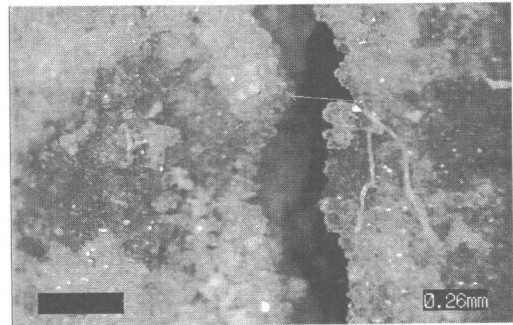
NC-1 ひび割れ発生後 13 日目
